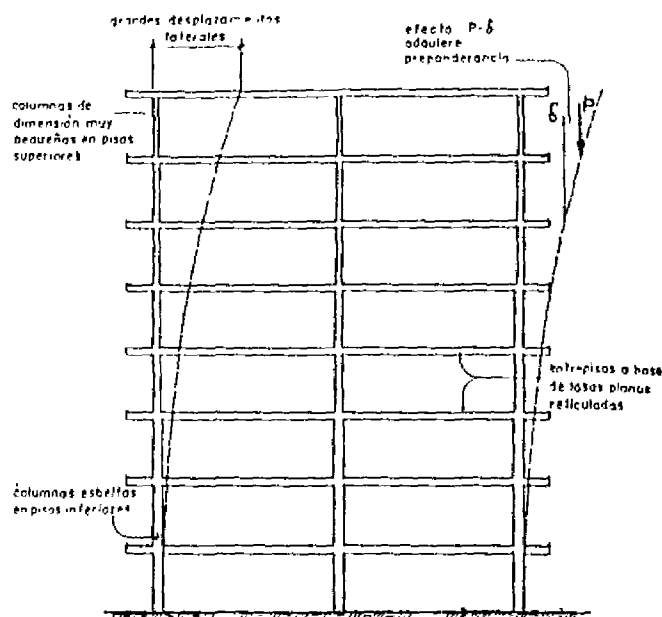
Colapso de sistema flexible a base de losas planas: edificio Rubén Darío - Terremoto San Salvador 1986
